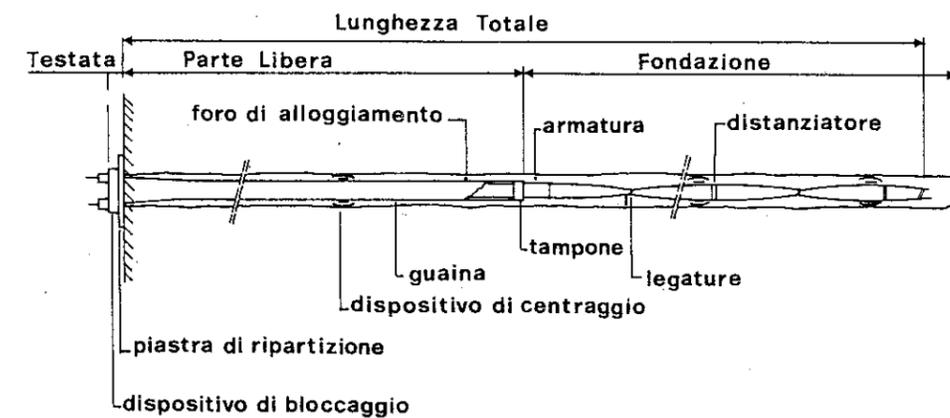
Rappresentazione schematica del tirante di ancoraggio
